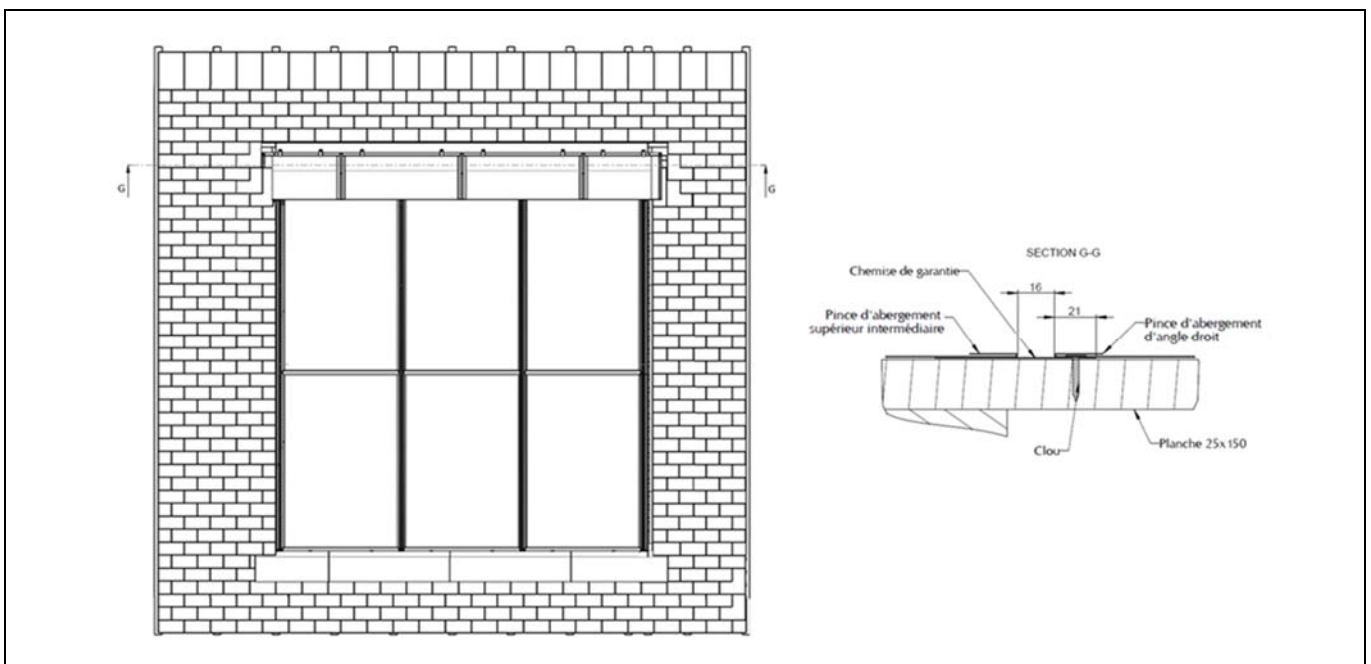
Pose des coulisseaux pour installation sur toiture tuile
